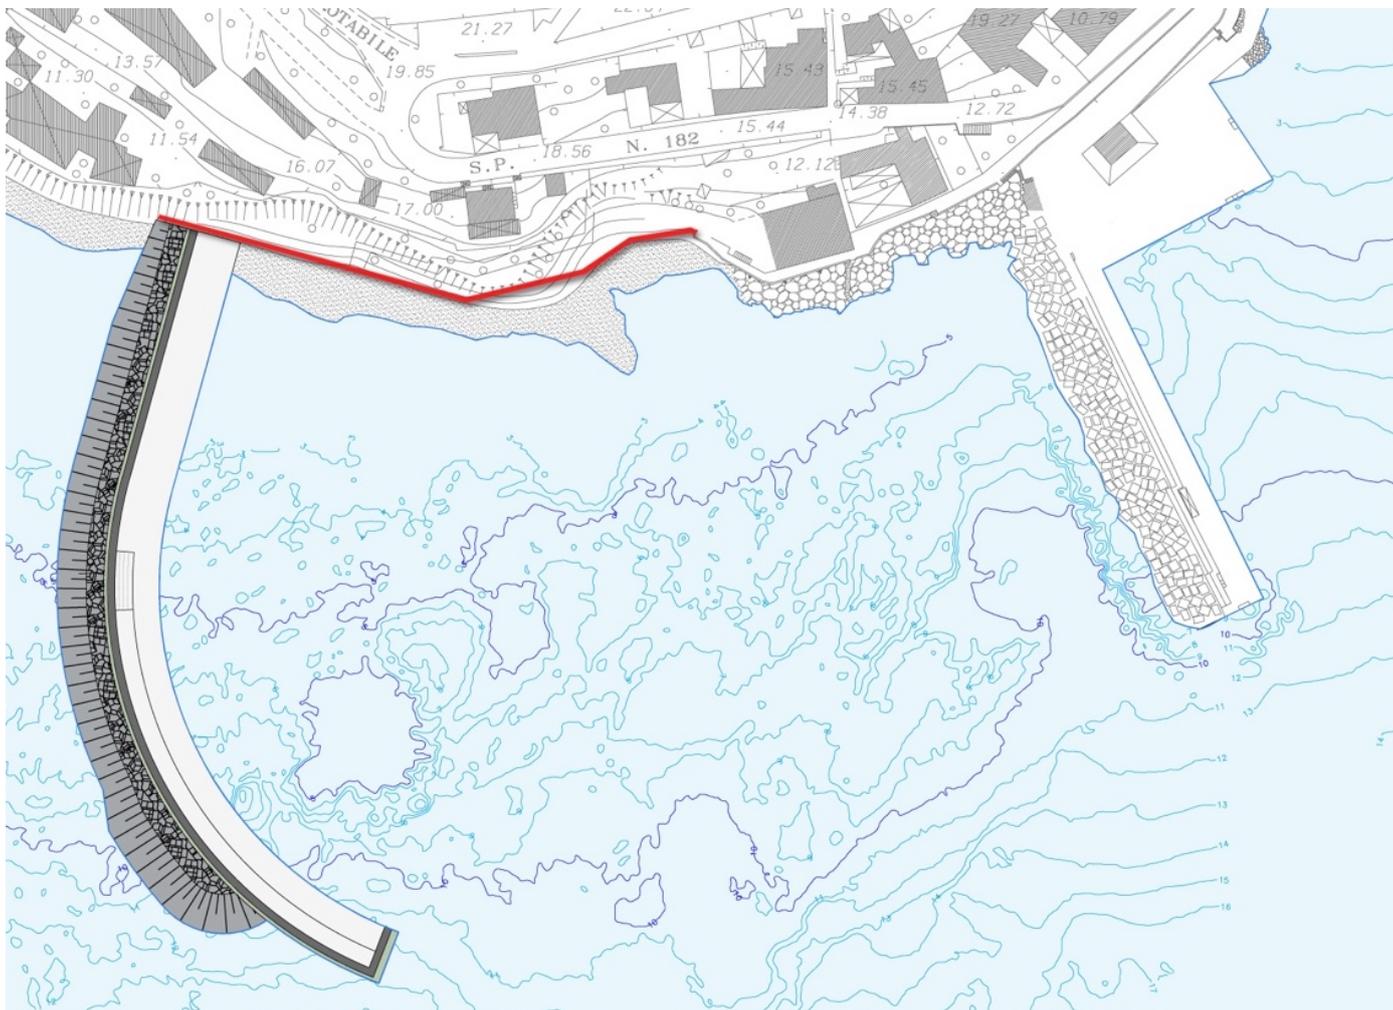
Stralcio planimetrico della proposta migliorativa
